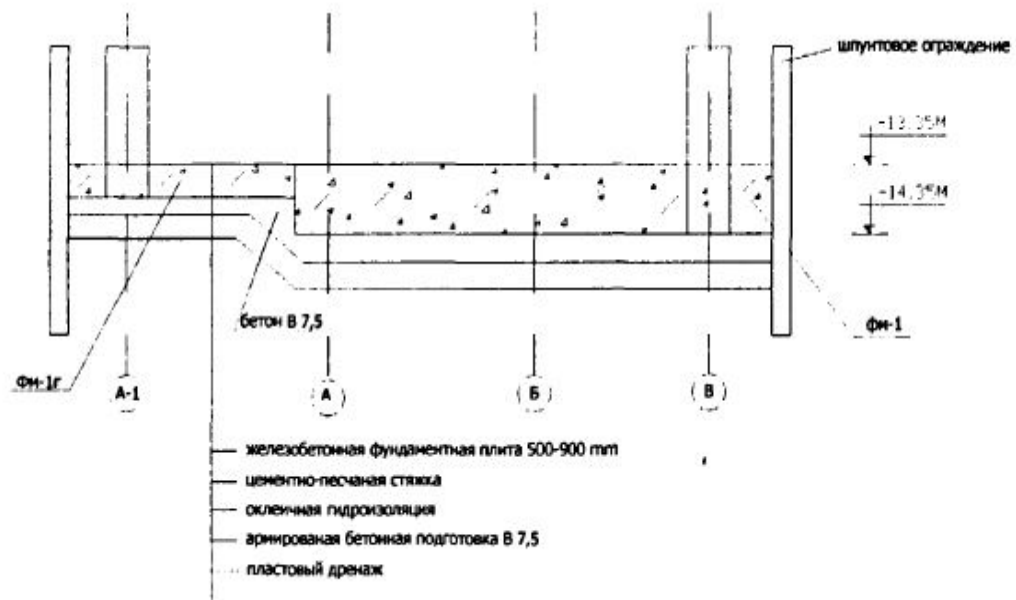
Розріз конструкції підготовки під фундамент та фундаментної ПЛИТИ
